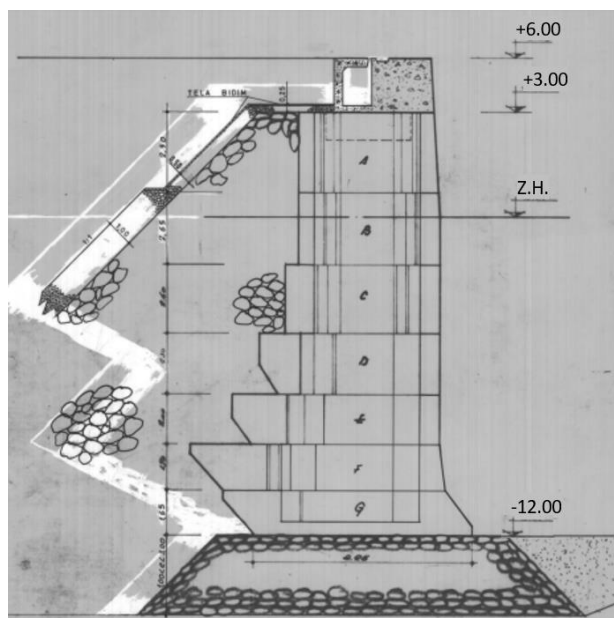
Cais Sul Doca n.º4 – Corte transversal tipo.
